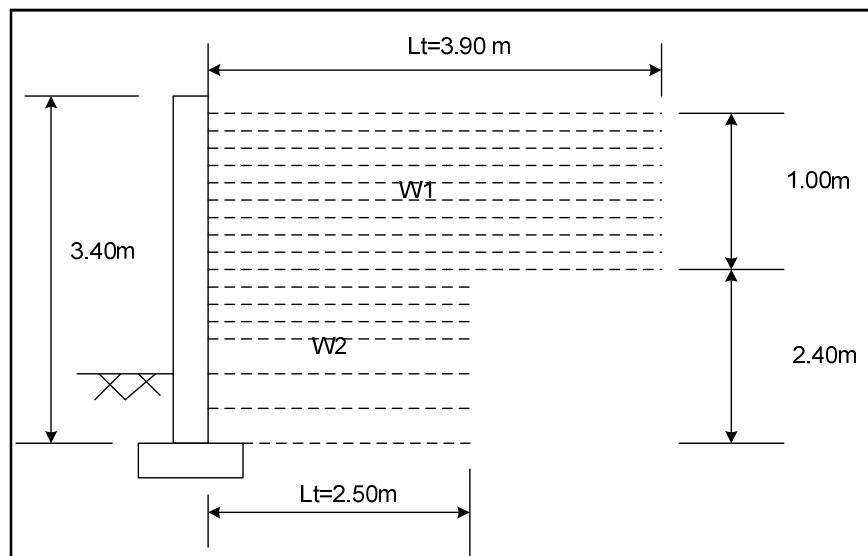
Fuerzas estabilizadoras iniciales muro 3 m
